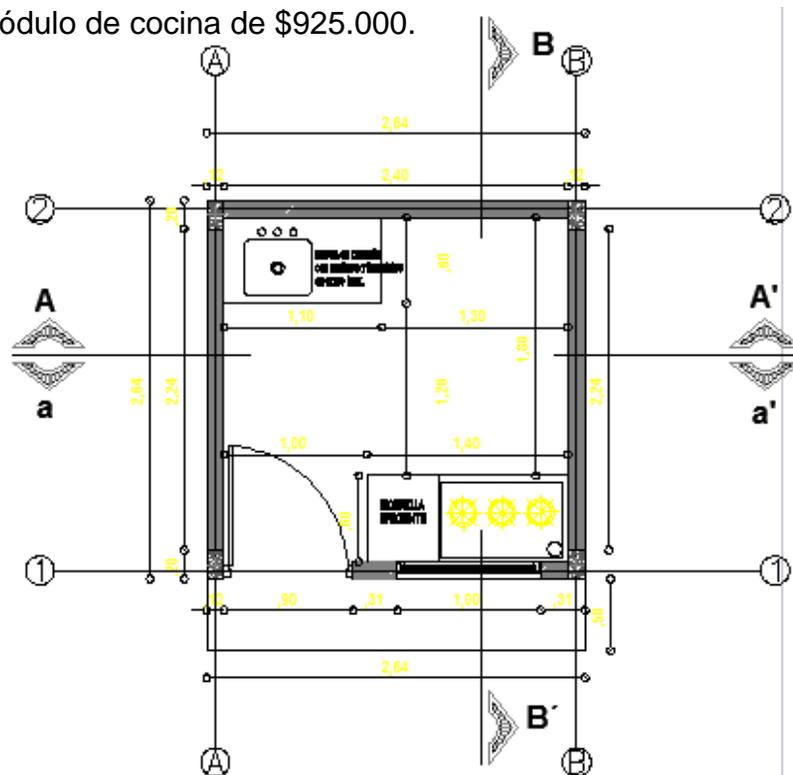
Planta plano arquitectónico proyecto Construcción de 132 cocinas en el Municipio de Rosas-Cauca Fuente: Archivo Fonade.
